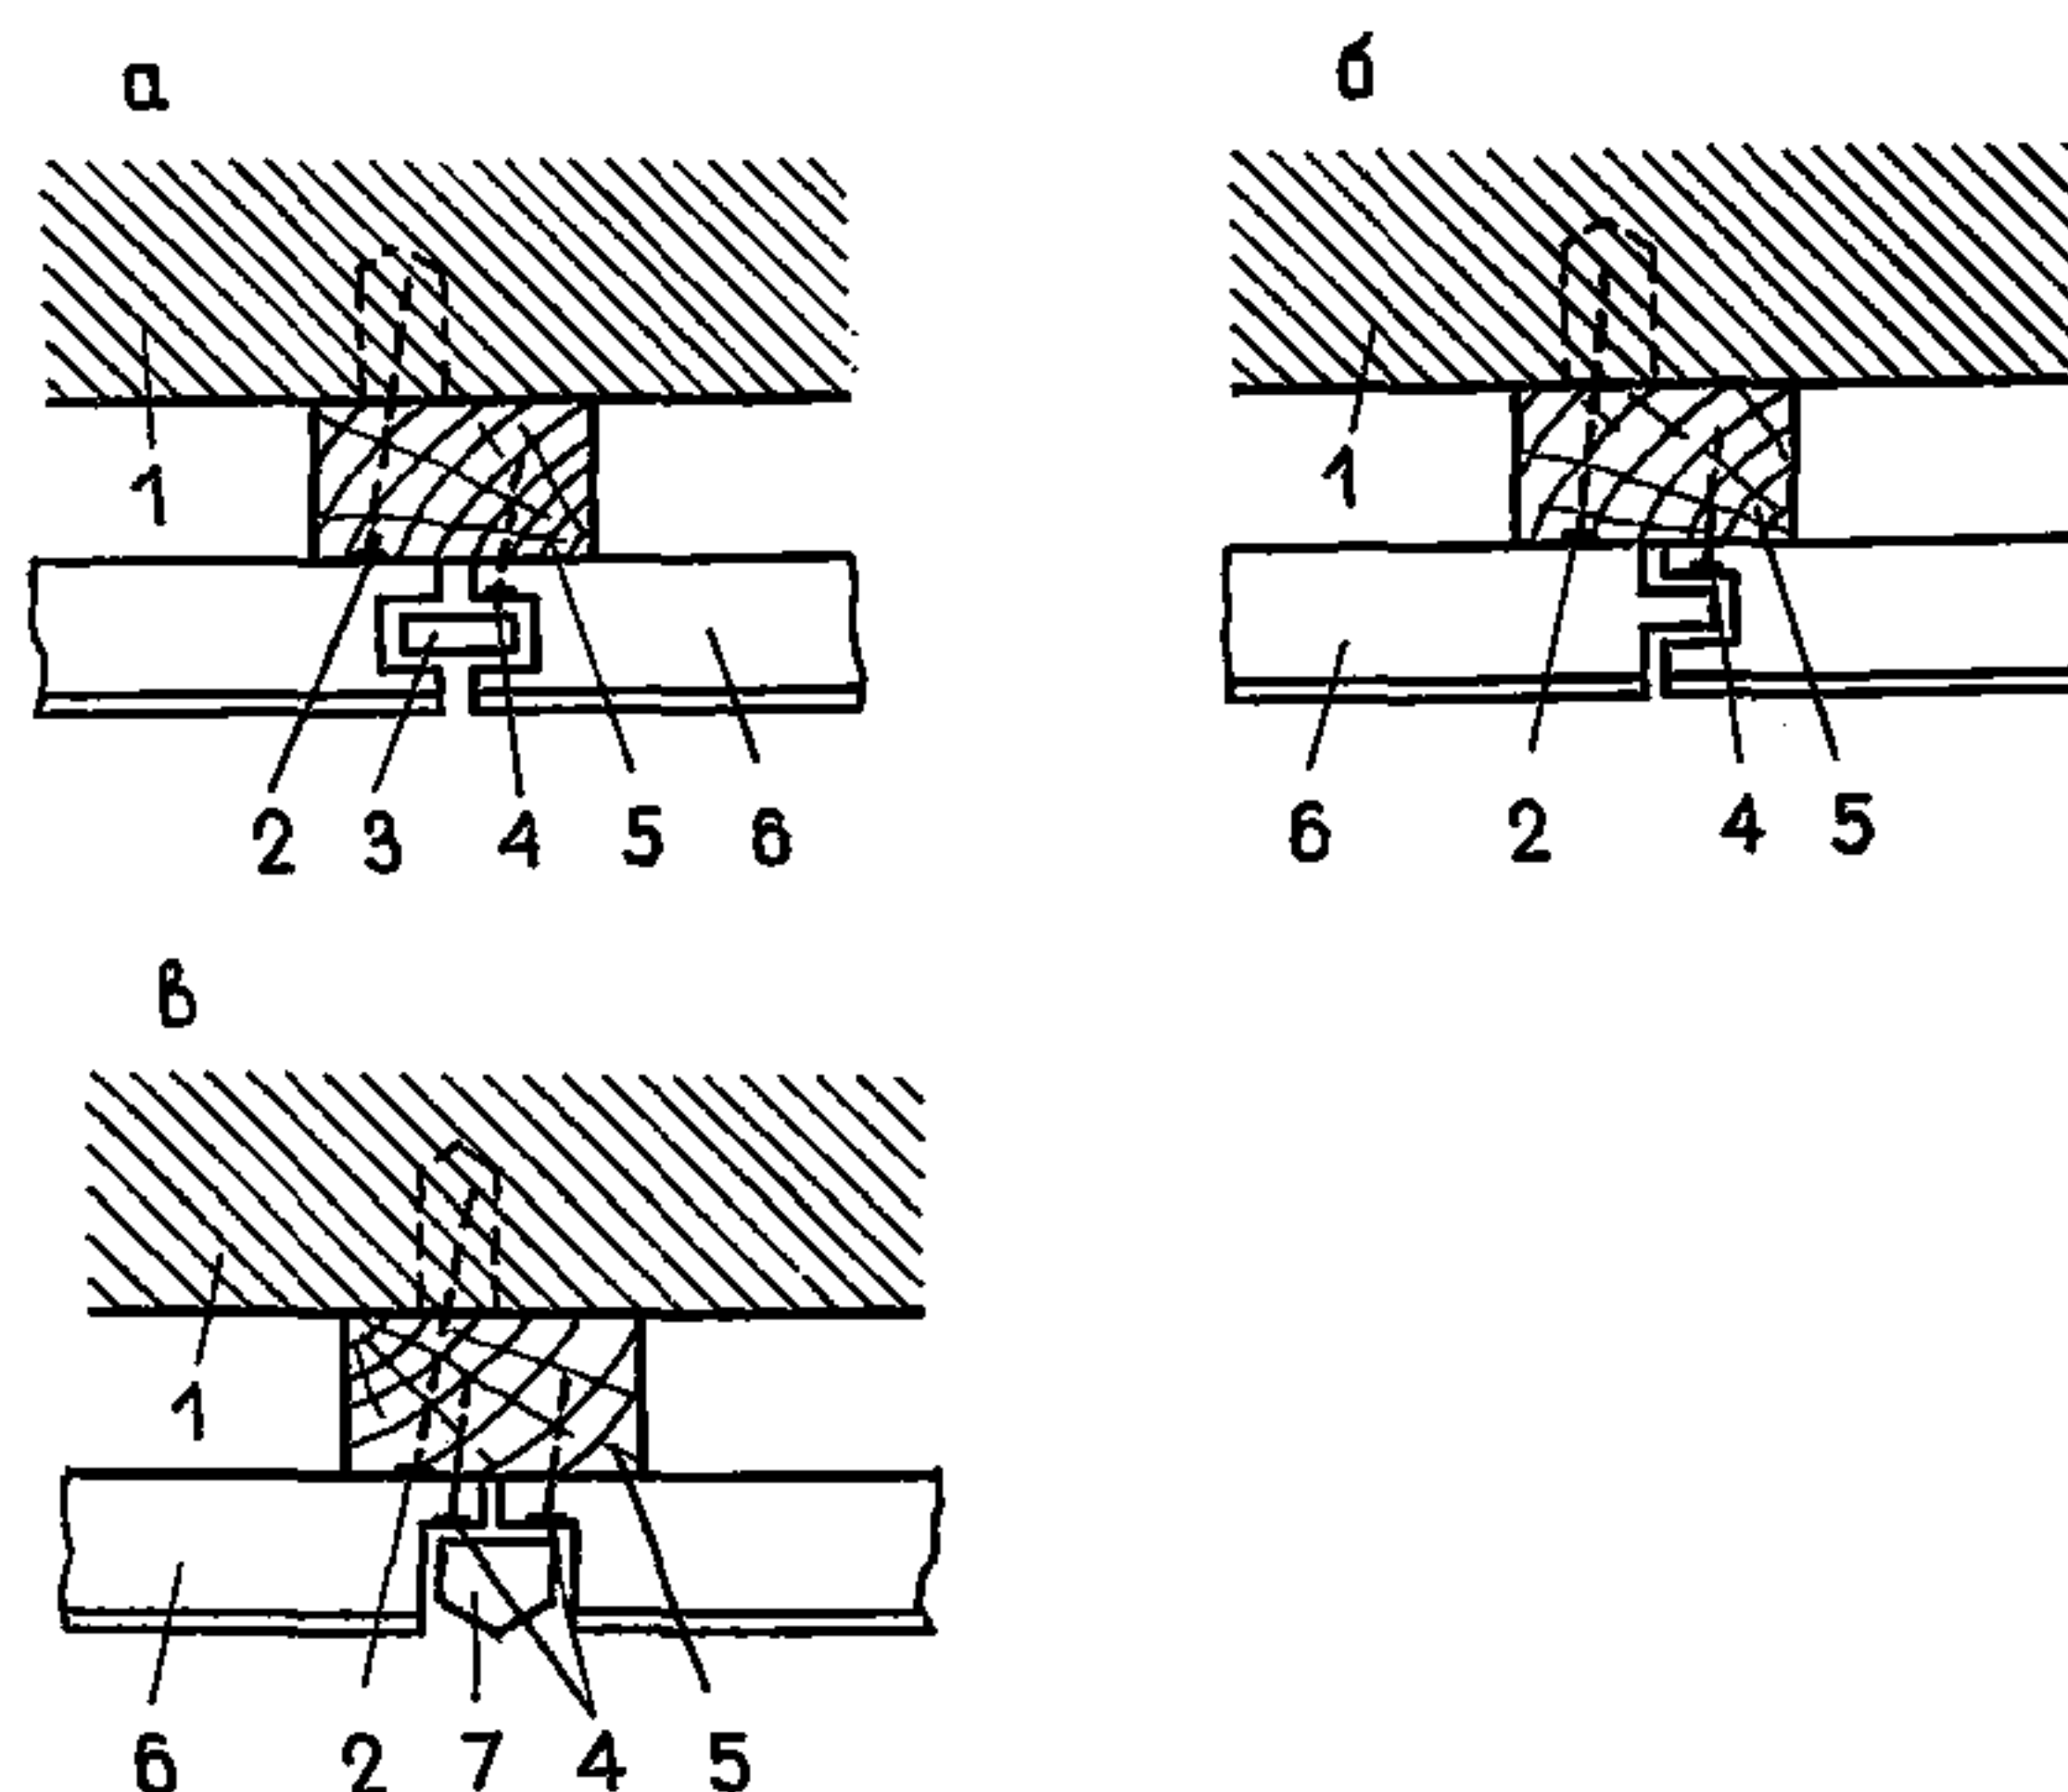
Схемы крепления панелей, офанерованных шпоном из ценных пород древесины
